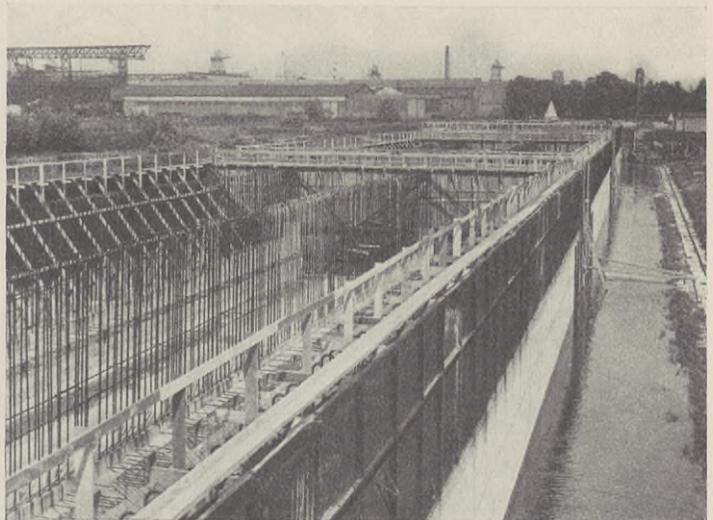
Tunnelstücke fertig zum Ausschwimmen.
